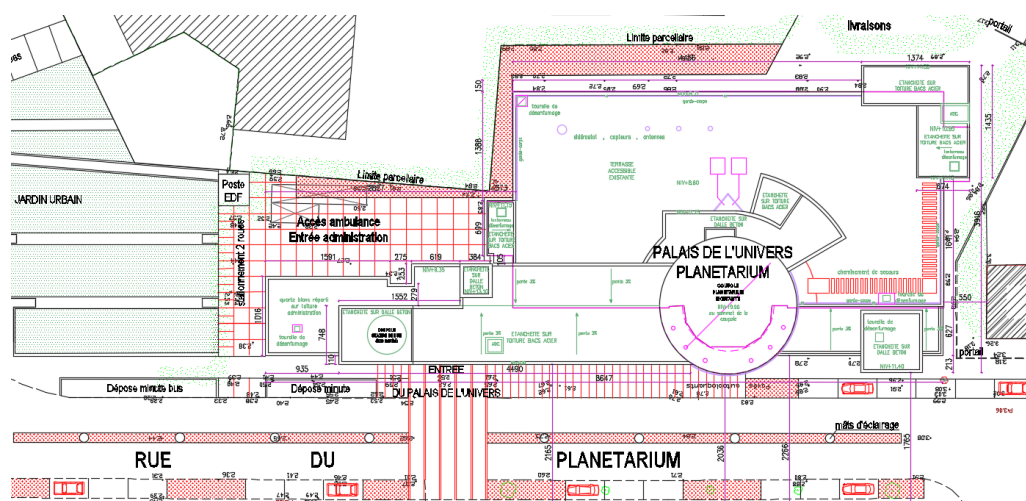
Plan masse du PLUS. Plan fourni par la CUD
